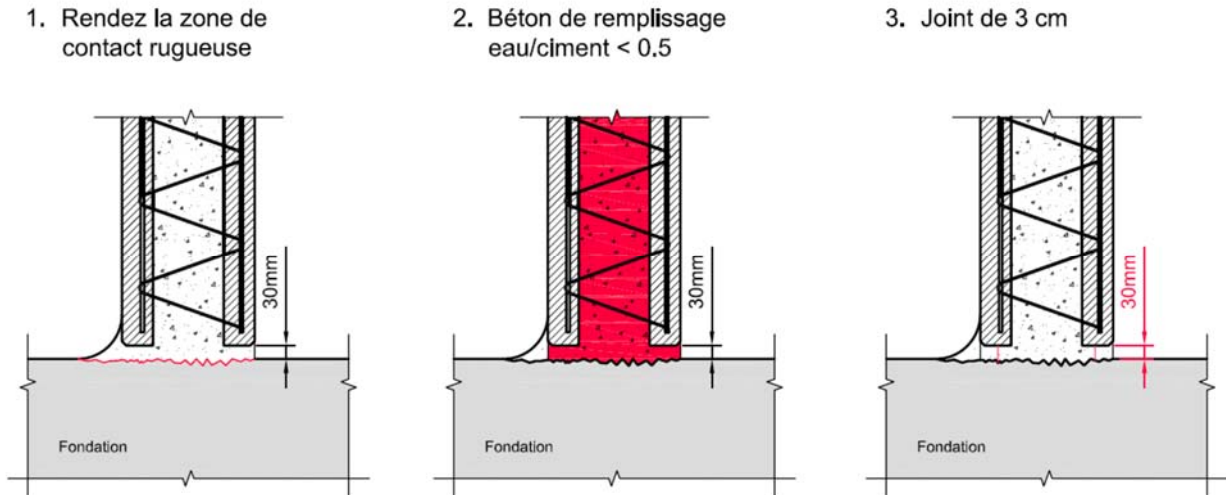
Détails d'étanchéité – liaison en pied de mur
